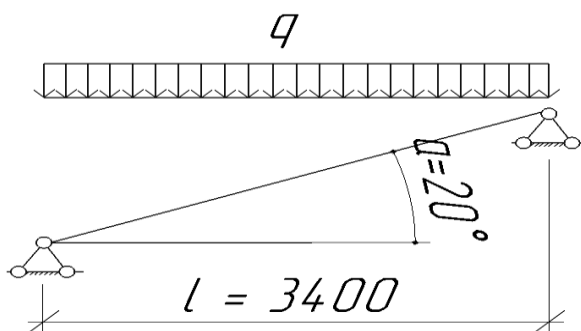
Расчетная схема однопролётной стропильной ноги
